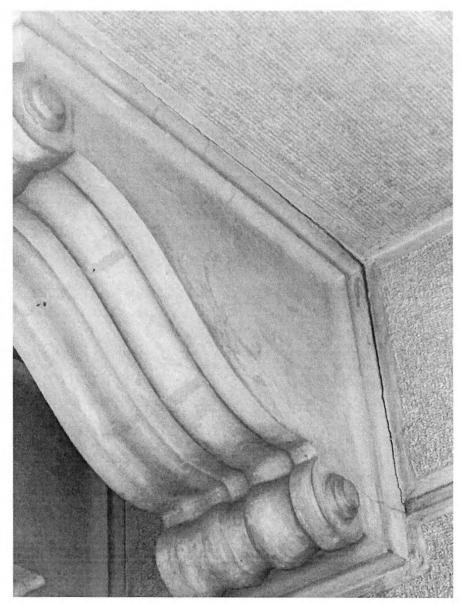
Fisuras en elementos ornamentales en fachada sur.
